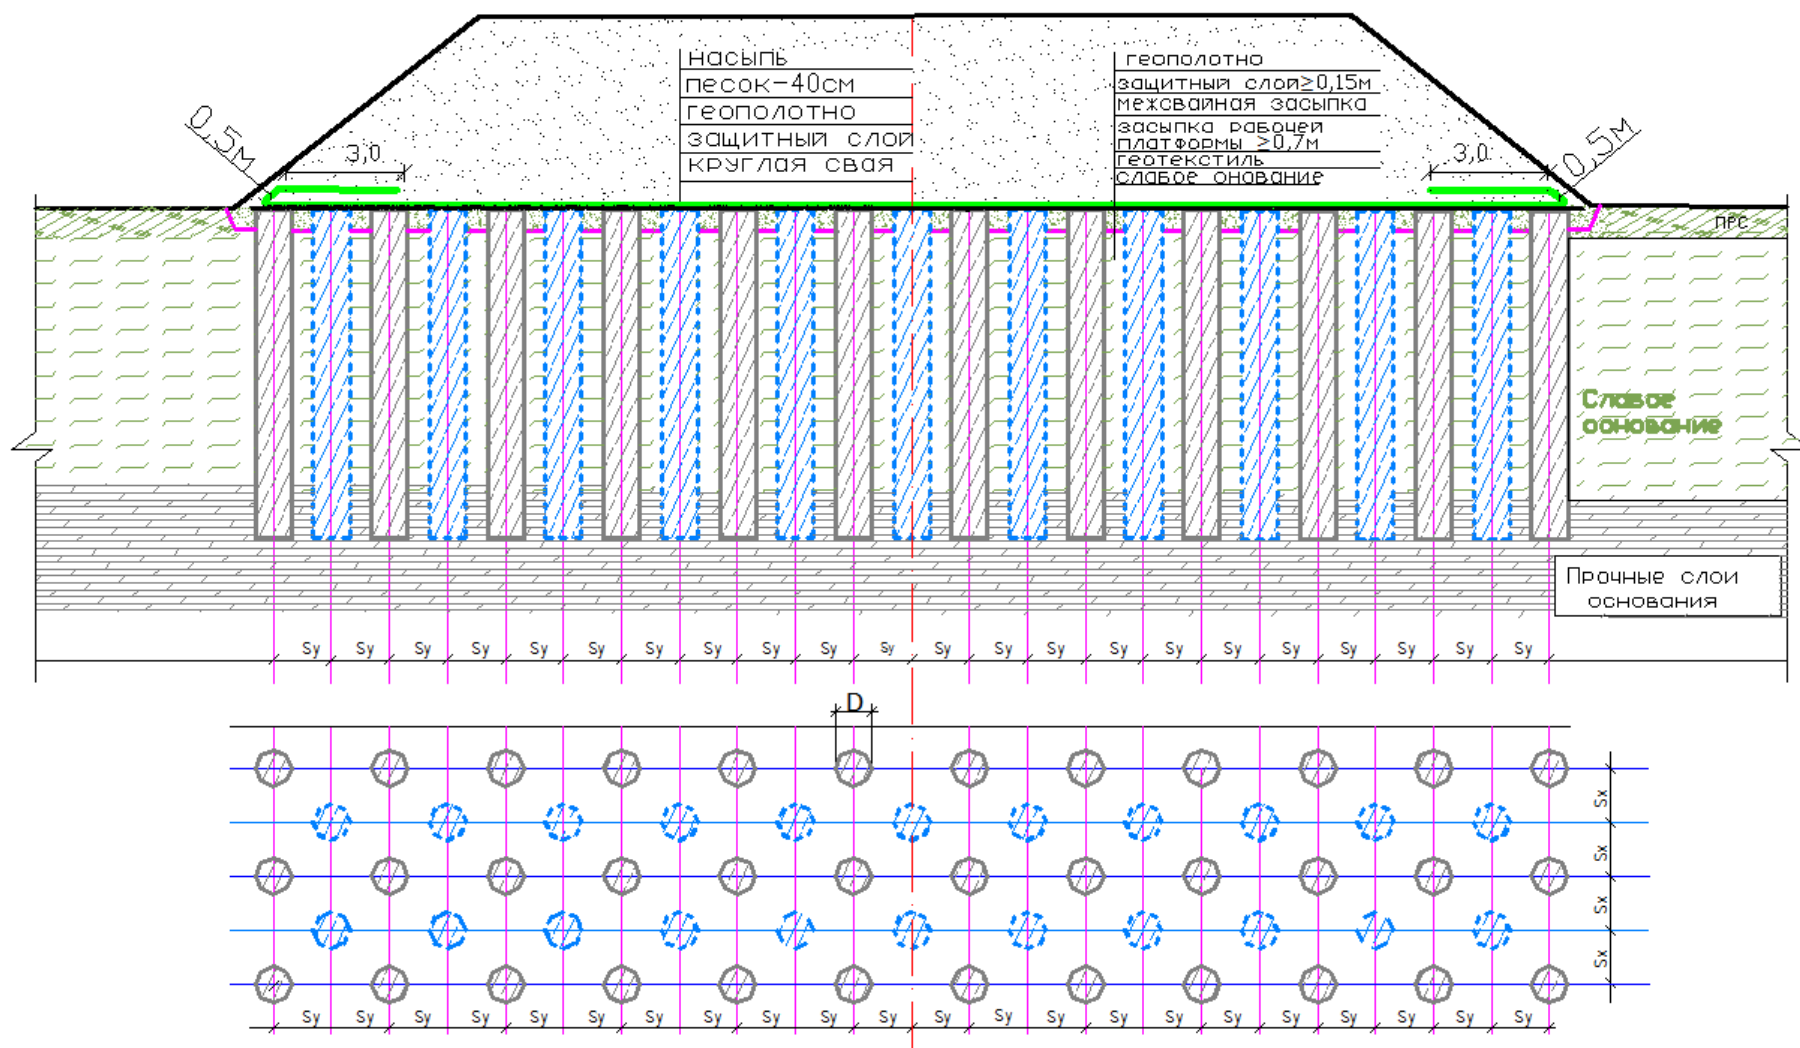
Гибкий ростверк из одного слоя геополотна с песком на круглых сваях (с размещением свай по треугольной сетке «в шахматном порядке»)
